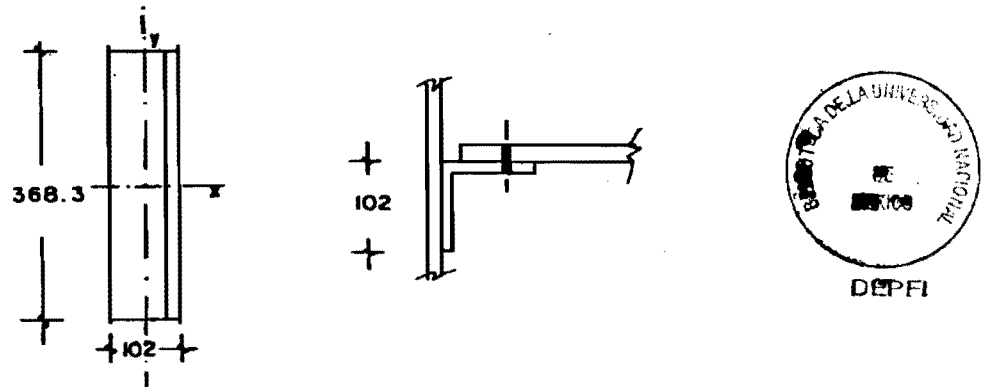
Contorno de la soldadura del angular.
